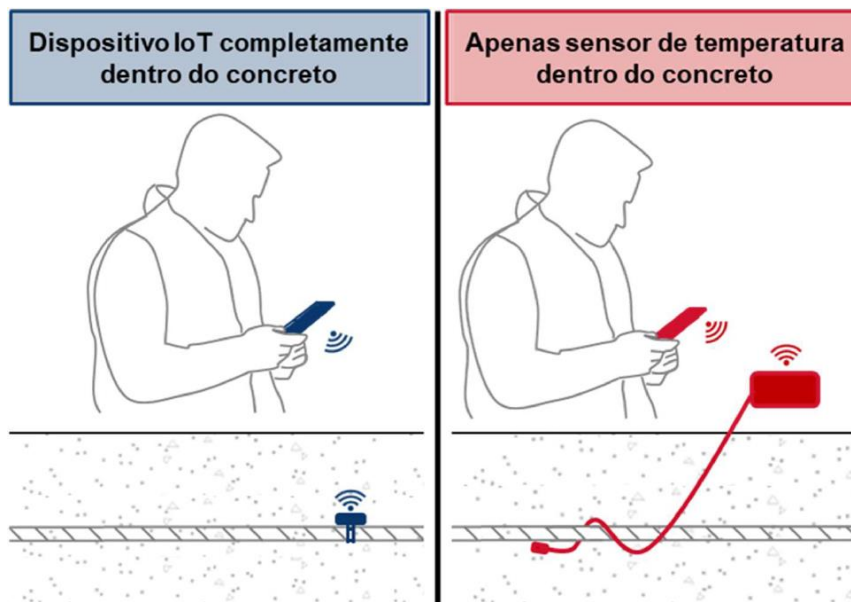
Diagrama esquemático de instalação de sensores fixos no pavimento
